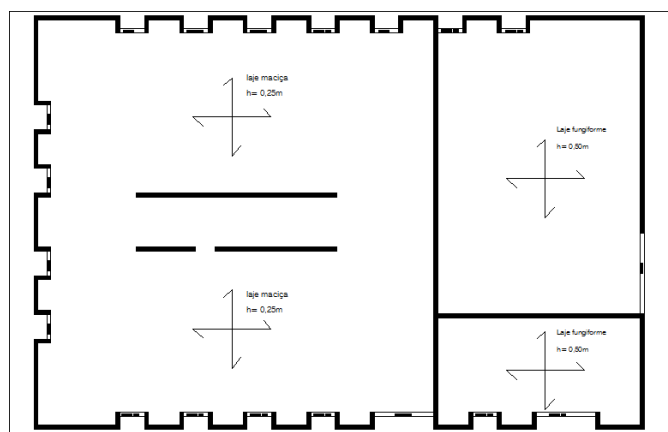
Planta Estrutural cobertura do módulo A (s/escala)
